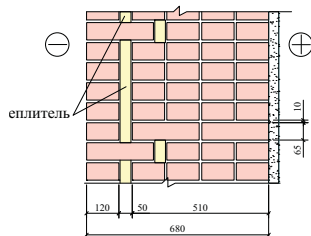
в Разрез стены из кладки с уширенным швом
